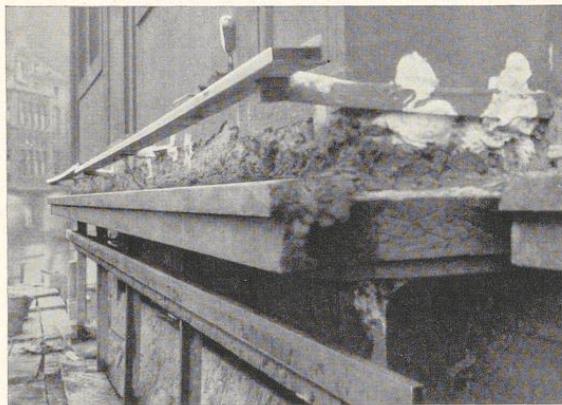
Der Anschlag für ein Gurtgesims an der Fassade
